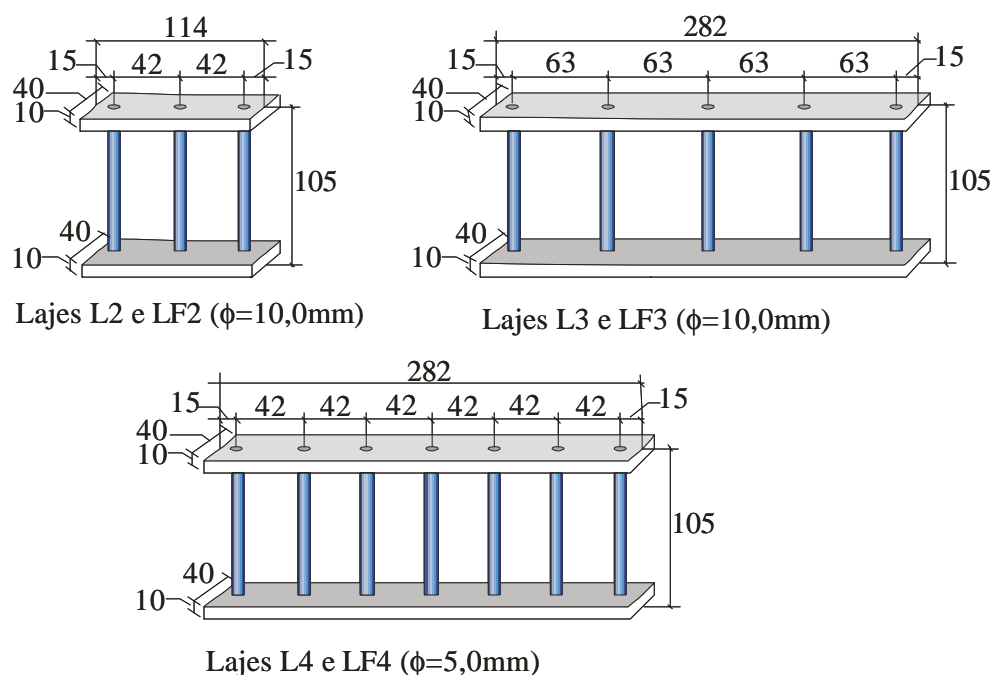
Armadura de cisalhamento (MUSSE, 2004)
